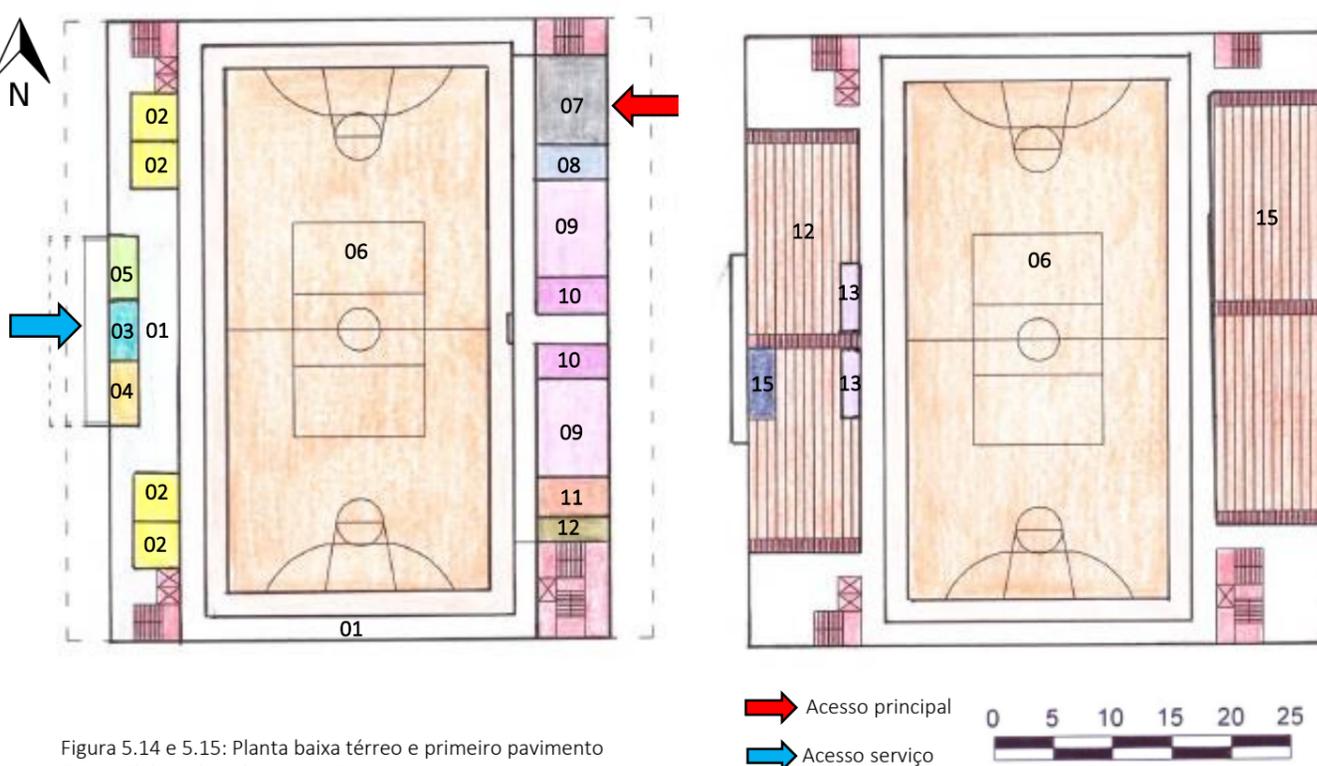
e 5.15: Planta baixa térreo e primeiro pavimento
